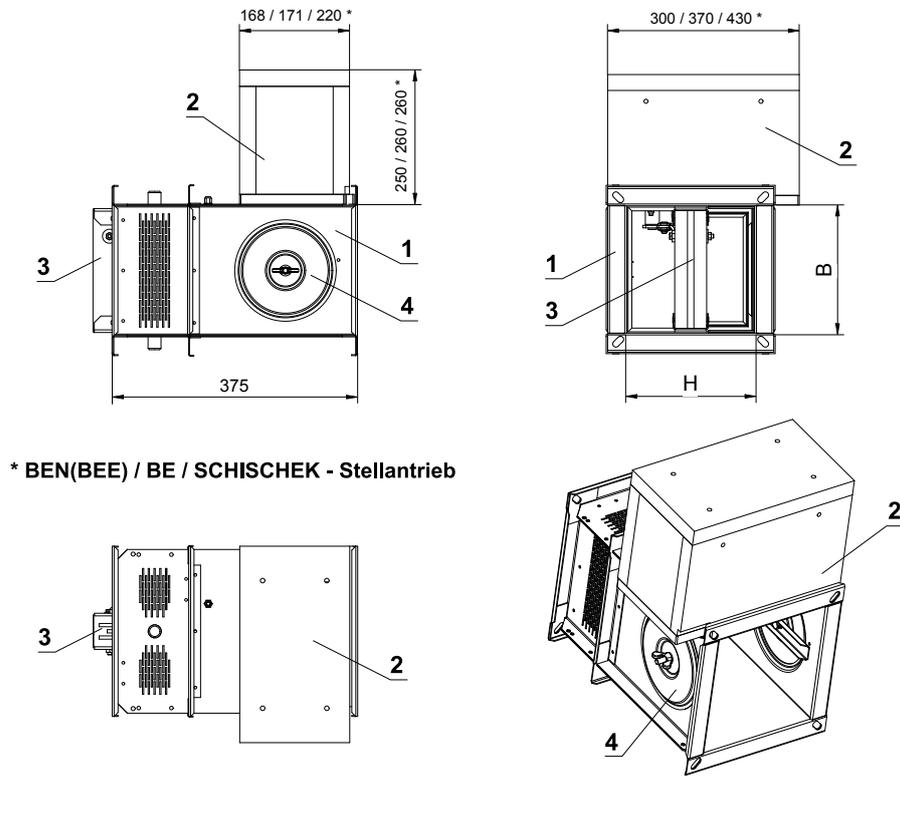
Eckige Entrauchungsklappe - Ausführung mit Stellantrieb und Gehäuse
